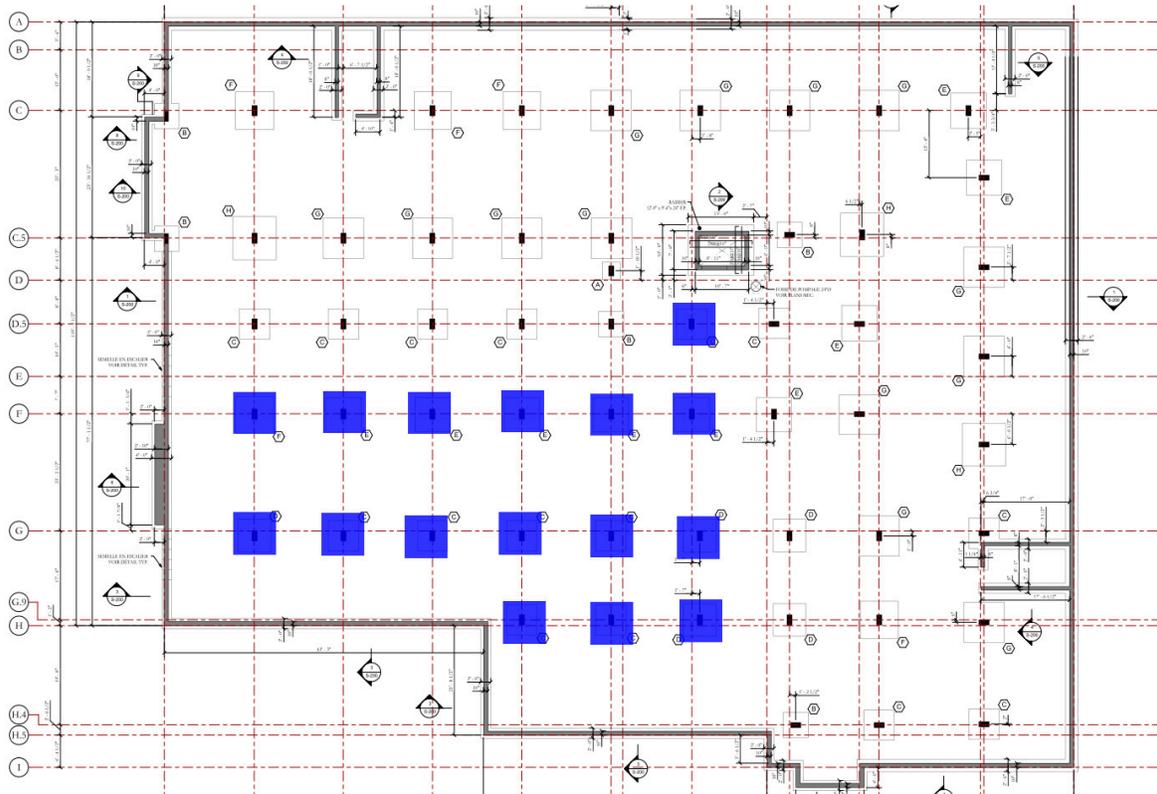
Semelles Types - Cas #3 - Dimension, Armature et Coût total approximatif
